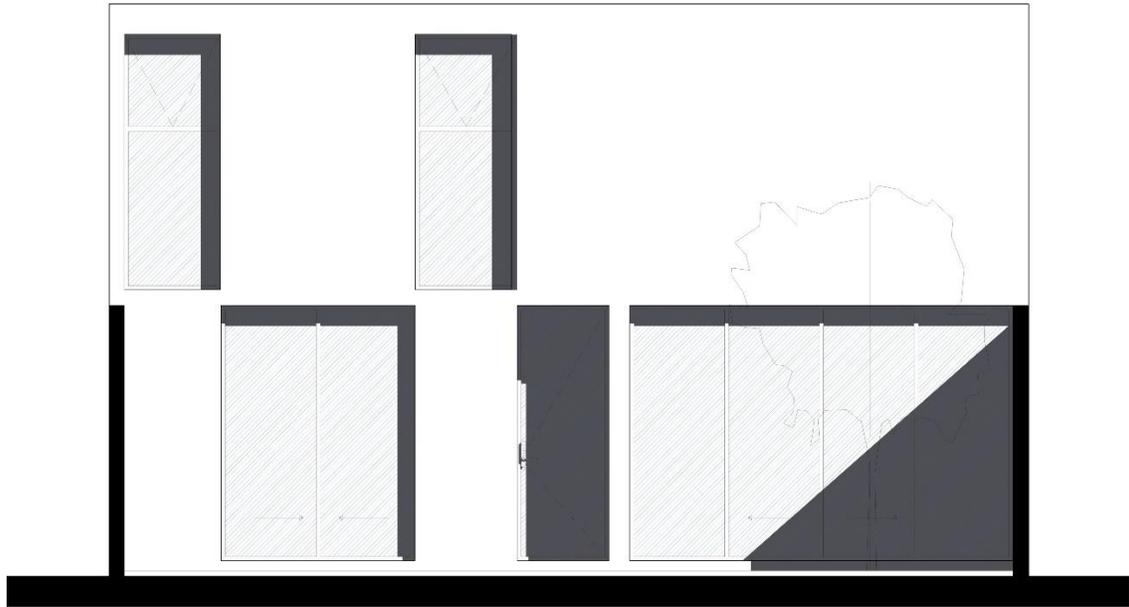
Corte longitudinal esquemático de la vivienda
